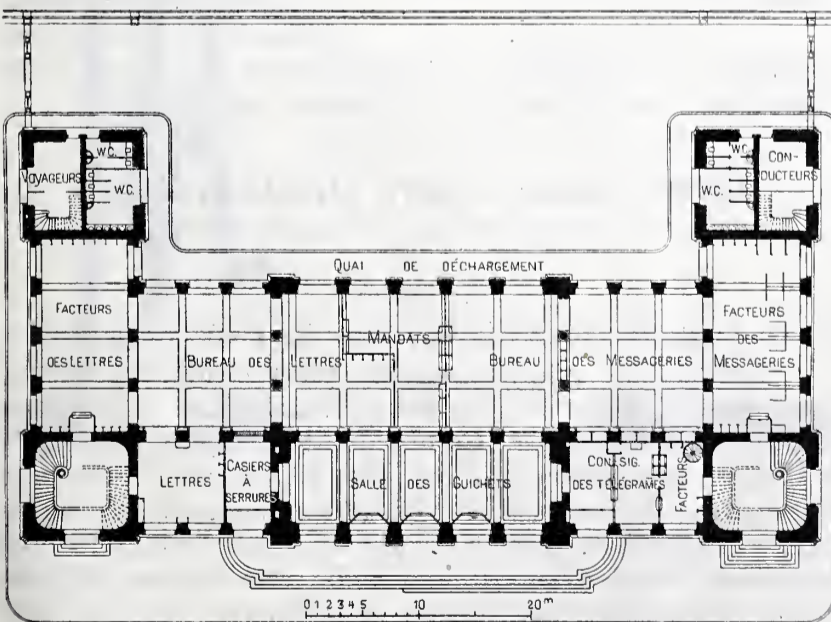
Plan du rez-de-chaussée. — Echelle 1 : 800.
